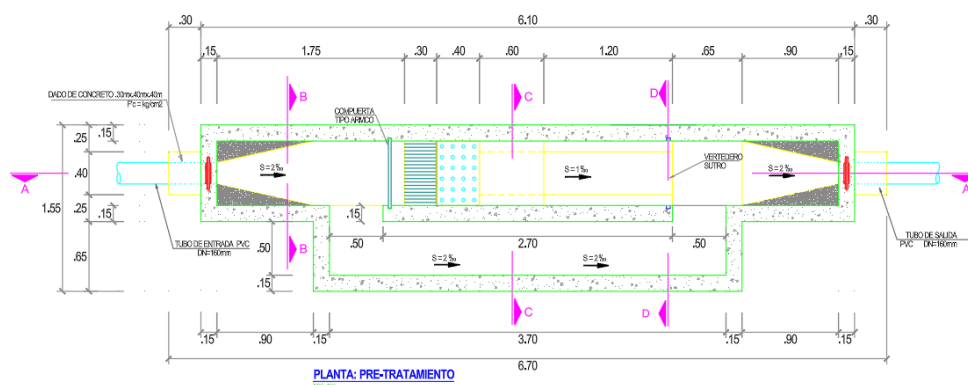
Planta de Pretartratamiento en sistema colectivo multifamiliar
